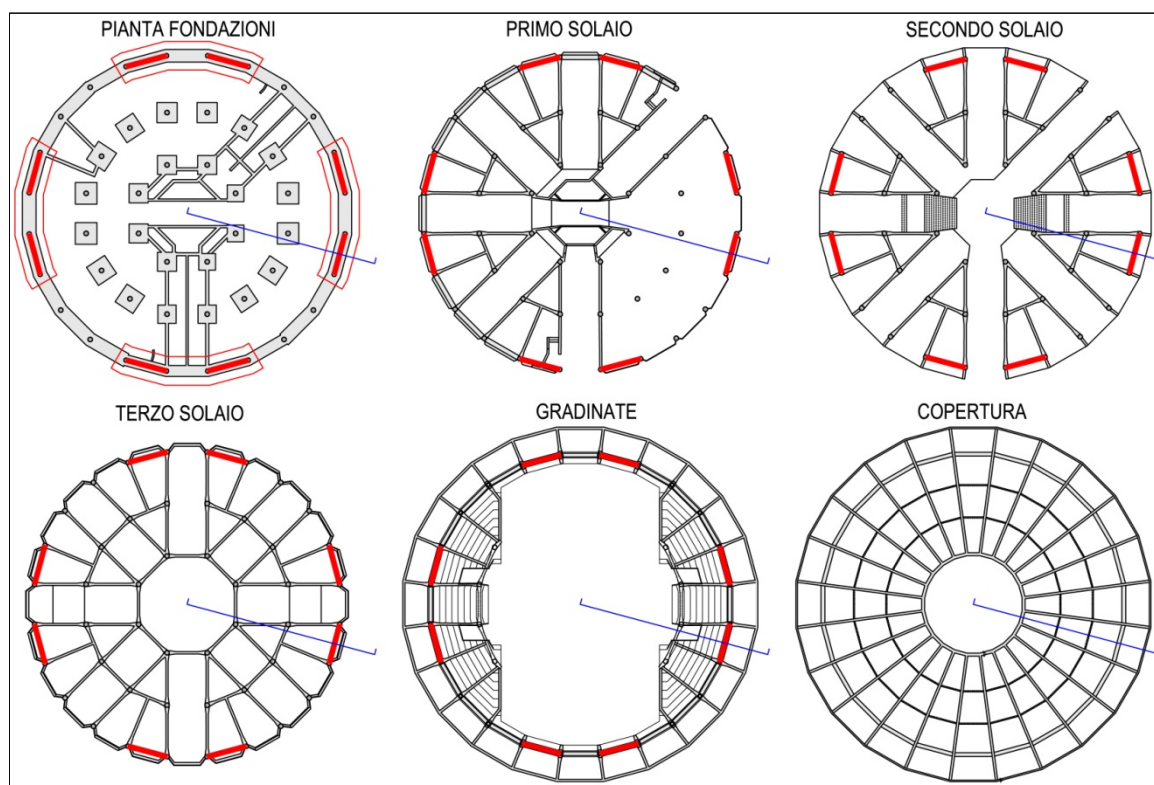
schema planimetrico degli interventi (in rosso le nuove costruzioni)
